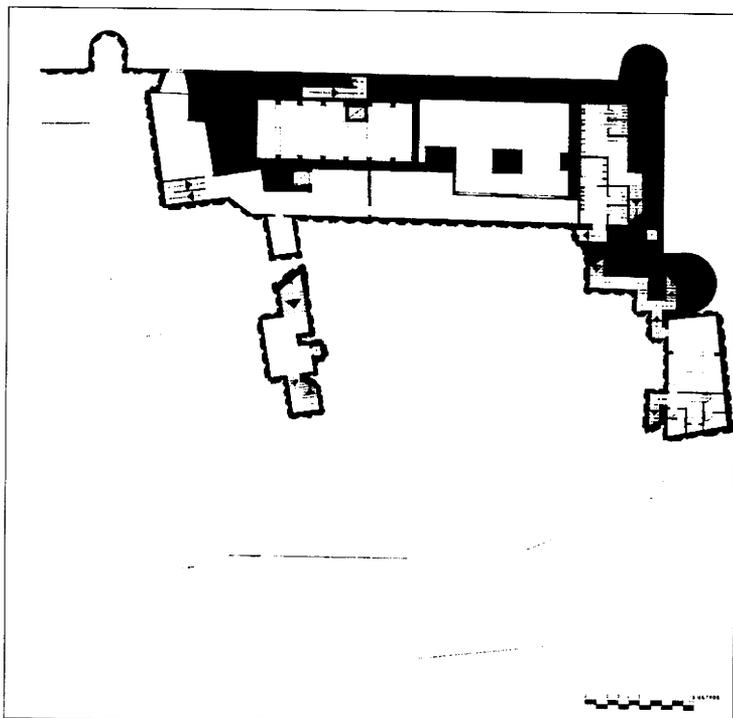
Planta do piso intermédio, criado durante as obras de adaptação a pousada
